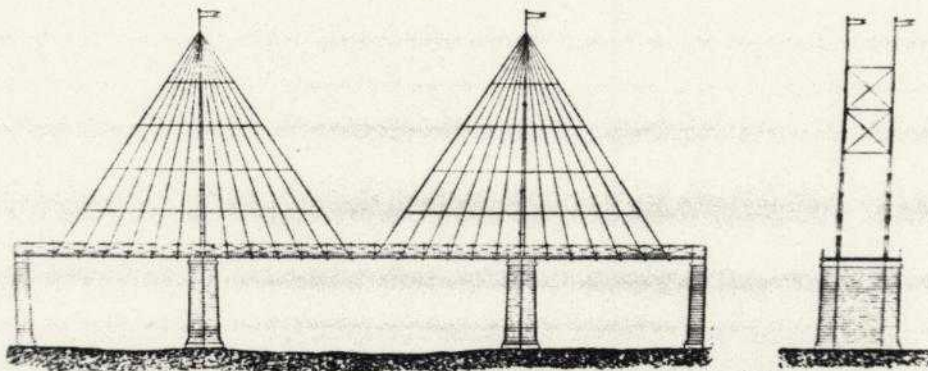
Pontes estaiada com arranjo em leque, proposta por Poyet (França, 1821)
